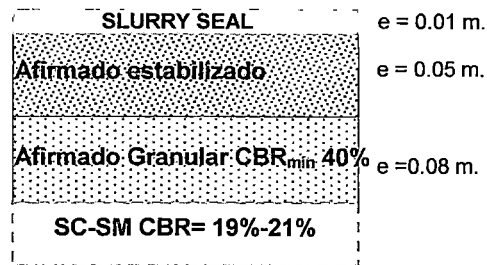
Estructura del pavimento con Slurry seal⁴⁷.
